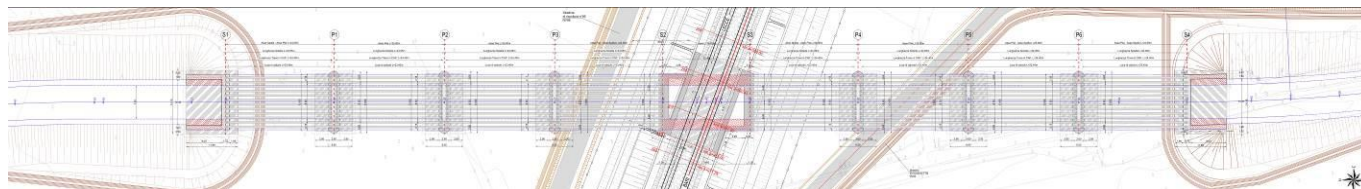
Planimetria cavalcaferrovia "Rafaschieri"
